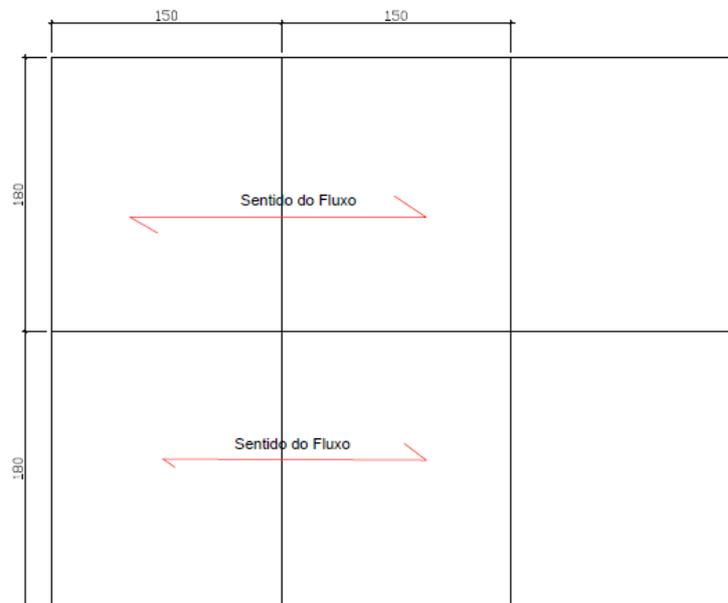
Detalhamento técnico das juntas de dilatação para a produção dos pisos em concreto.
